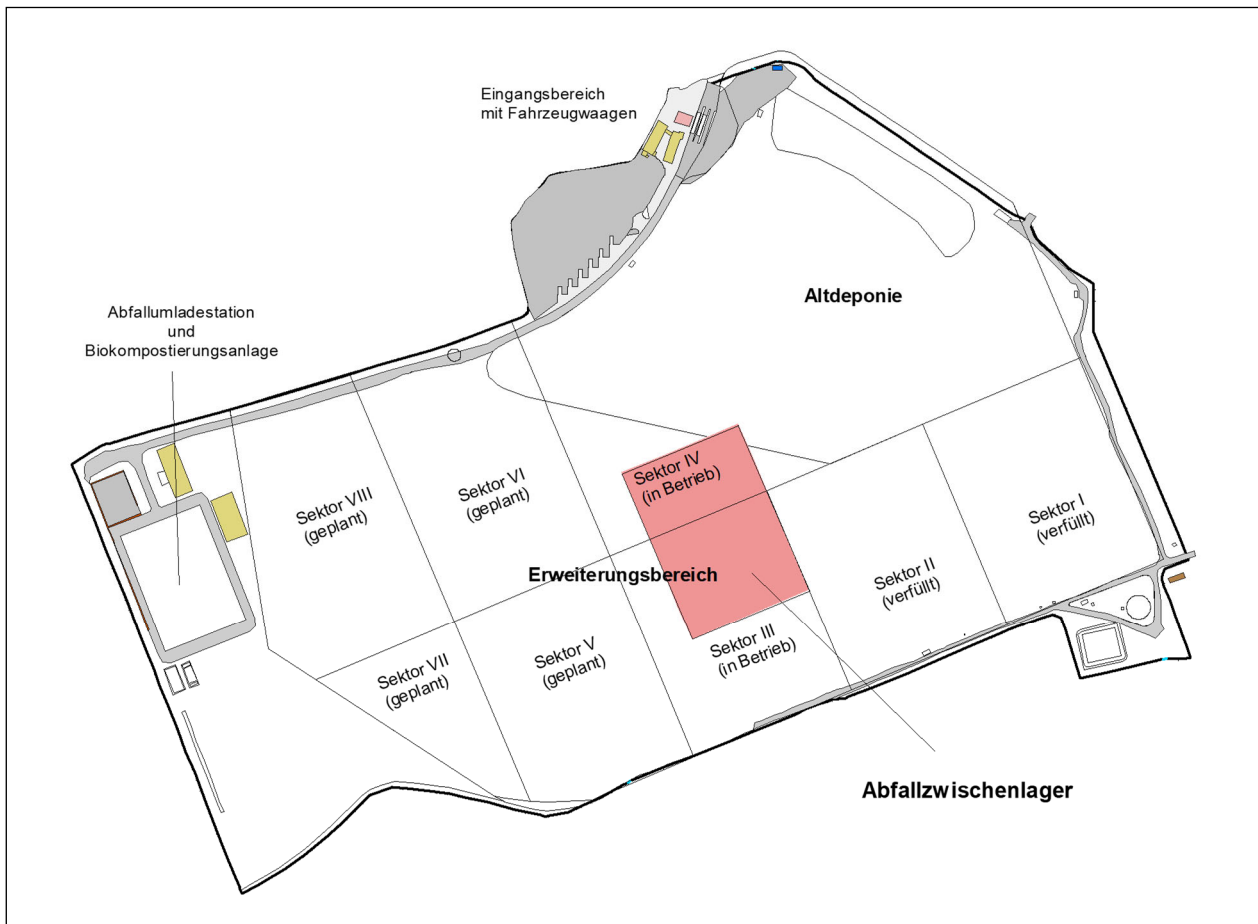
Lageplan Deponie "Kirschenplantage" mit Zwischenlagerfläche für Abfall
